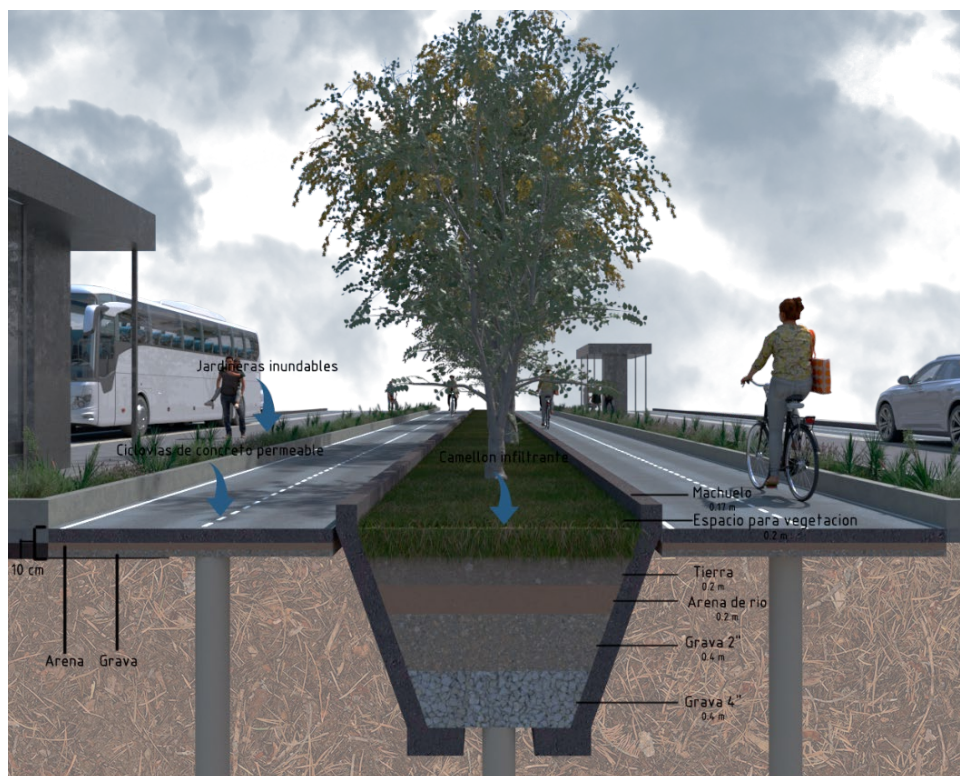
Detalle de jardinera, ciclovía y camellón filtrante.
